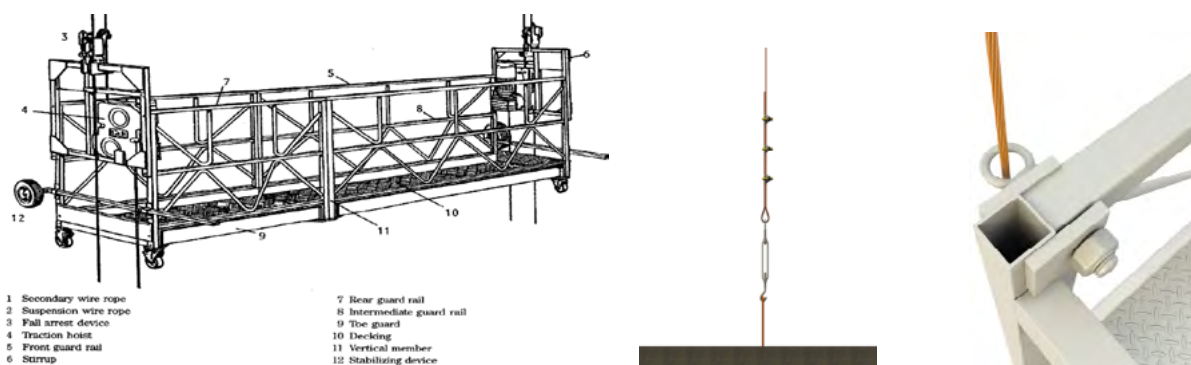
(a) Sistema de estabilización compuesto por ruedas que separan el andamio de la superficie de fachada; (b) Sistema de estabilización compuesto por cable de acero tensado
